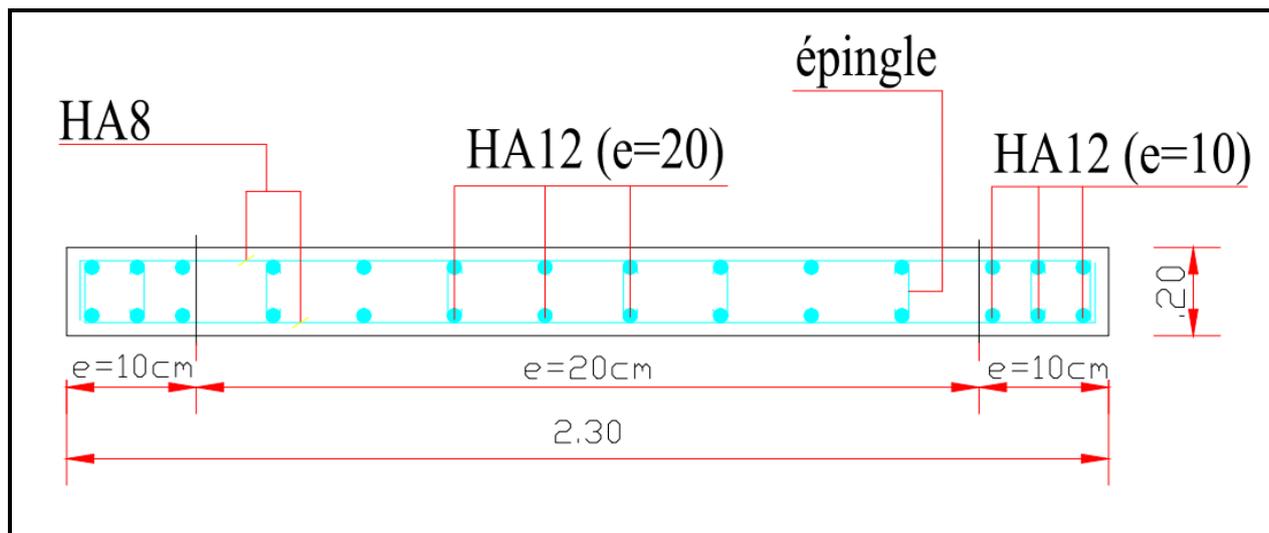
ferraillage coupe des voiles 01 (tous les étages).
